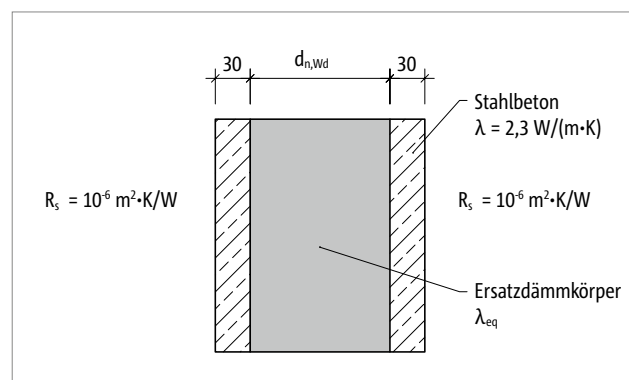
Ersatzdämmkörper gemäss EAD; zwischen zwei Betonplatten betrachtet
